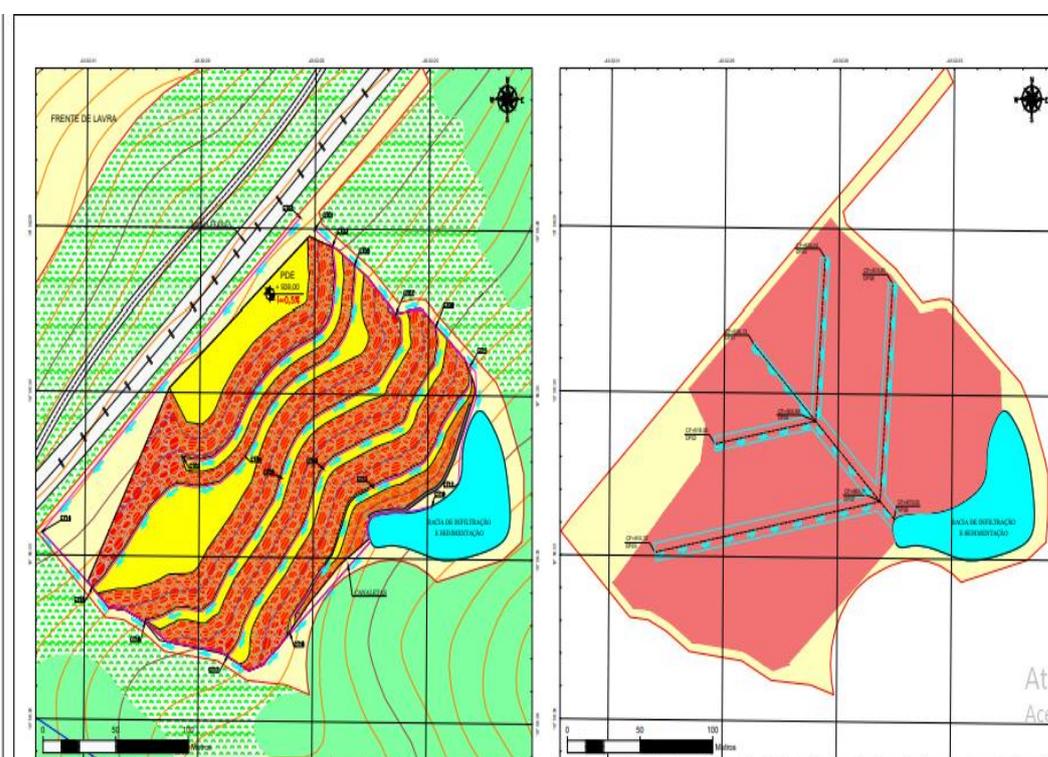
Sistema de drenagem da pilha de rejeito/estéril
